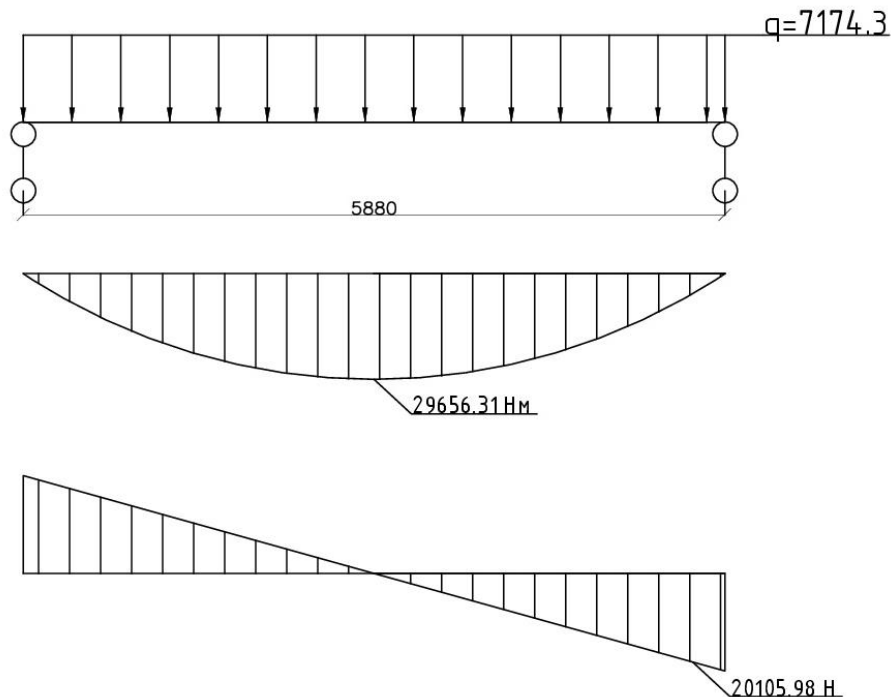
Схема навантажень на з/б плиту перекриття
